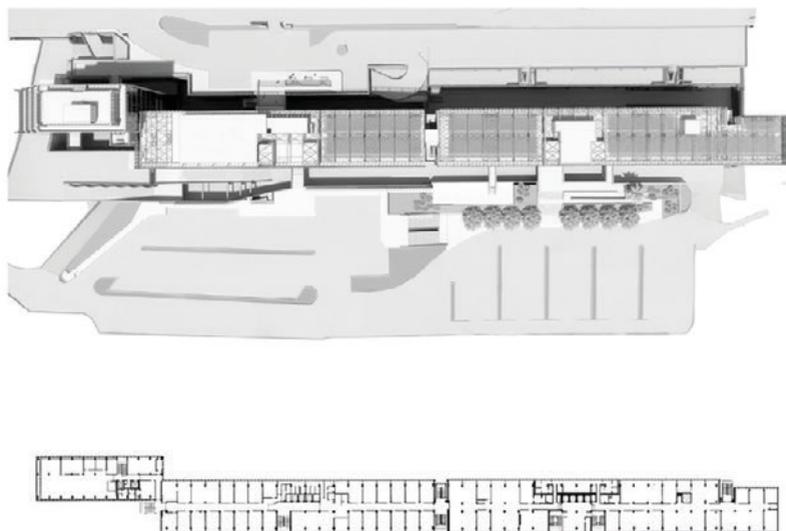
Planivolumetria generale di progetto (sopra), pianta piano tipo (sotto) [elaborazione degli autori].
